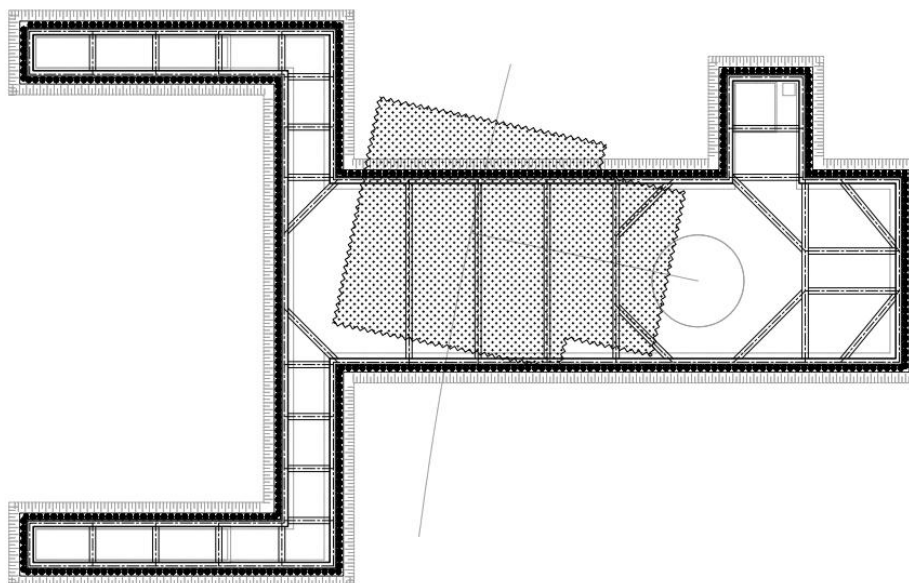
Esempio di opere di contenimento degli scavi per cabina tecnica e pozzo verticale – Vista in pianta.
